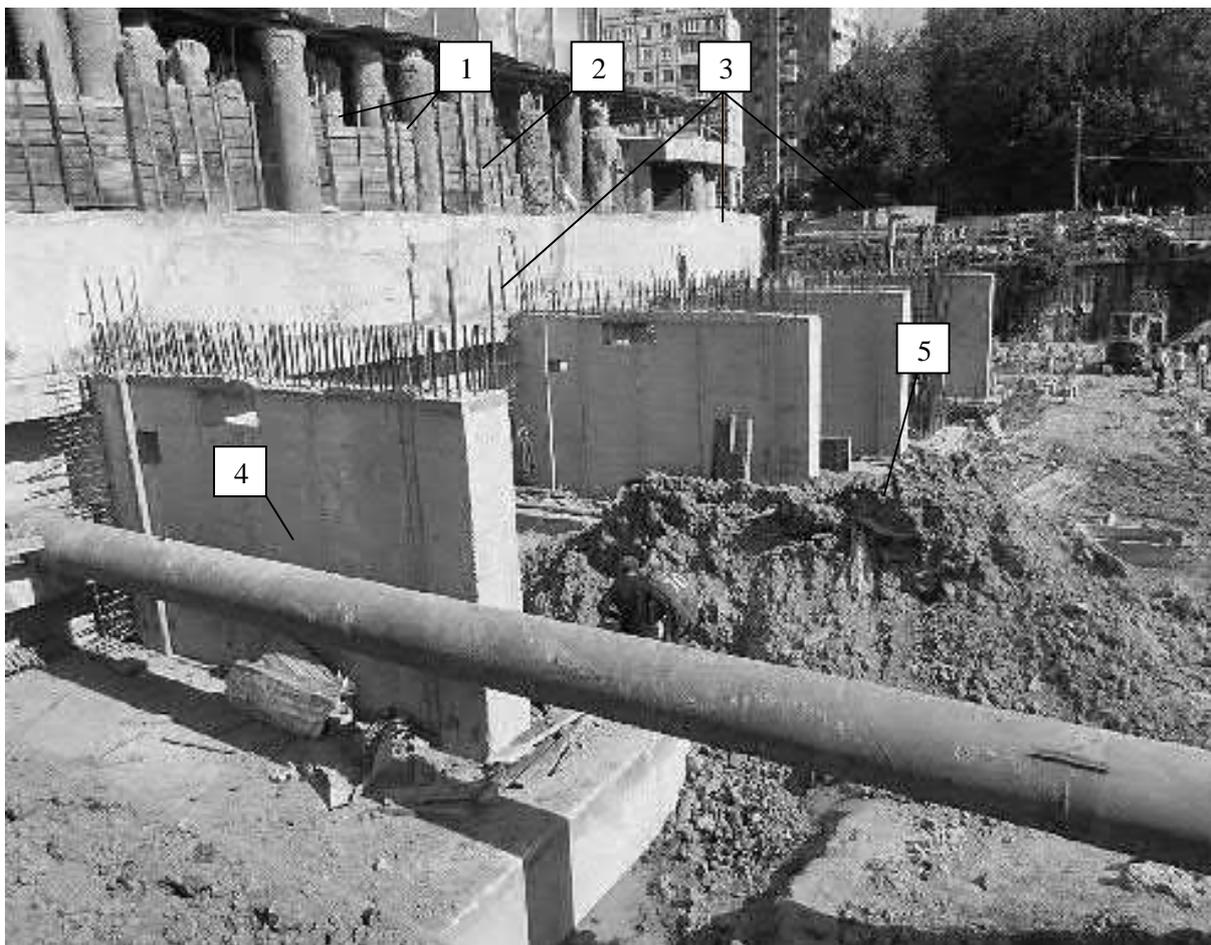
Фрагменты выполненных монолитных железобетонных контрфорсов: 1 - существующие буронабивные сваи ограждения котлована; 2 - ограждение котлована из монолитного железобетона; 3 - монолитные железобетонные контрфорсы усиления существующей подпорной стены; 4 - монолитный железобетонный ростверк; 5 - существующая труба - расстрел усиления
